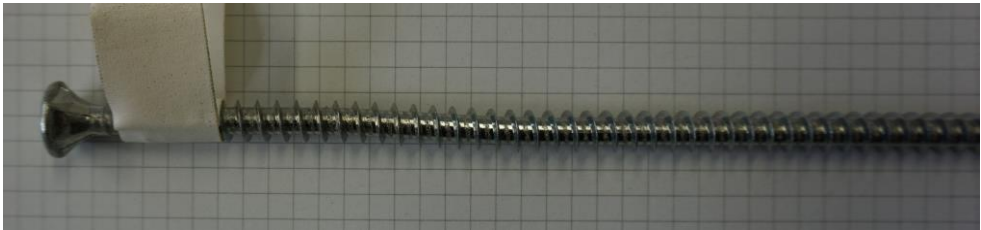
Fließgelenkausbildung an einer überwiegend axial beanspruchten Schraube (Schraubenposition 6)
